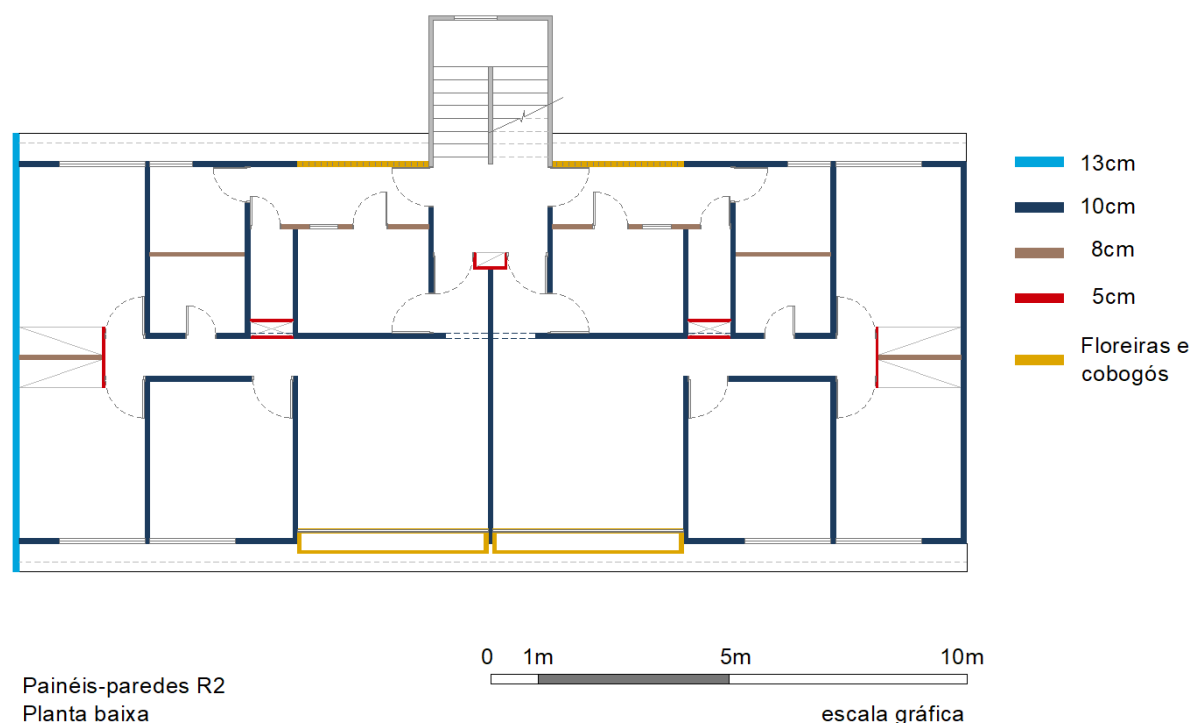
Planta com localização e espessuras dos painéis-paredes do R2. Fonte: da autora, adaptado das pranchas originais do Acervo do Arquiteto Milton Ramos.
